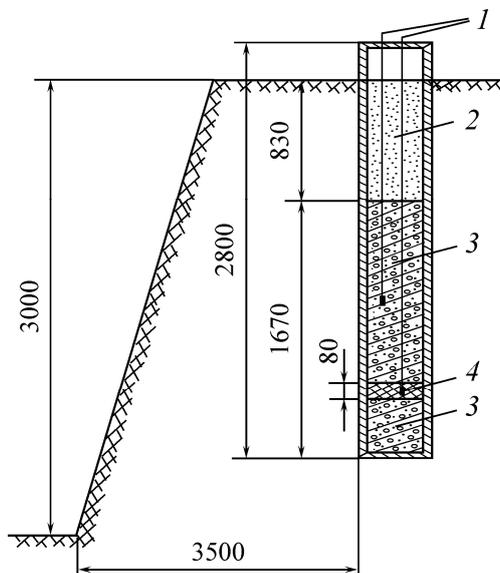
Конструкция скважинного заряда для дополнительного рыхления кучи с применением джезполита ДП-2АМ: 1 — зажигательная трубка; 2 — забойка; 3 — ВВ джезполит; 4 — инициальный заряд из промышленного ВВ
